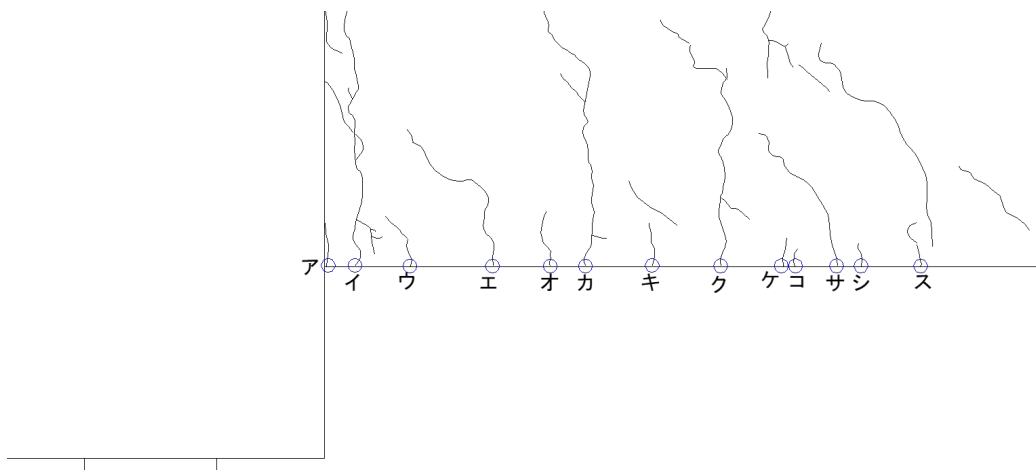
基礎梁ひび割れ幅測定位置 (試験体 C-2 正載荷)
